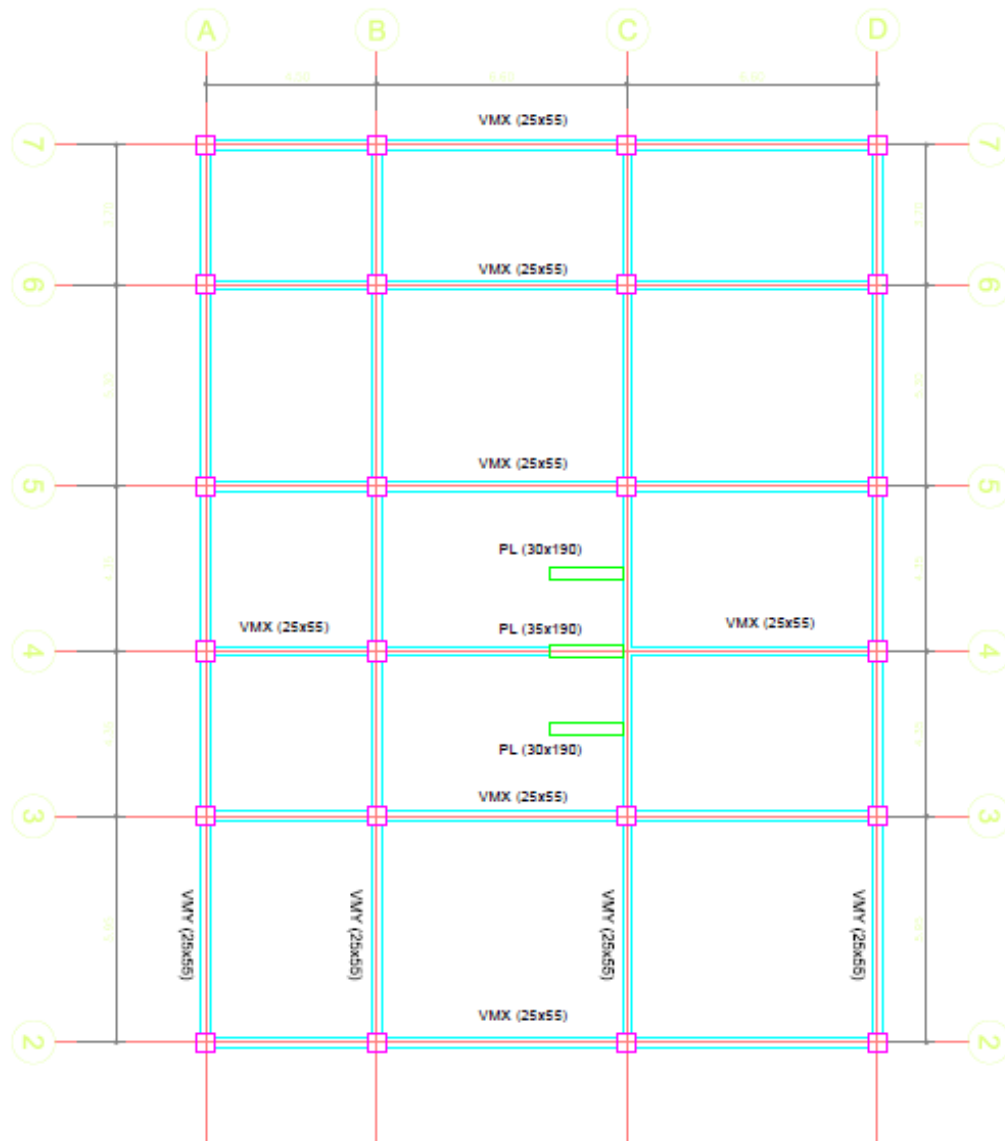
Planta arquitectónica del edificio sin techo verde pisos 1 y 2.
